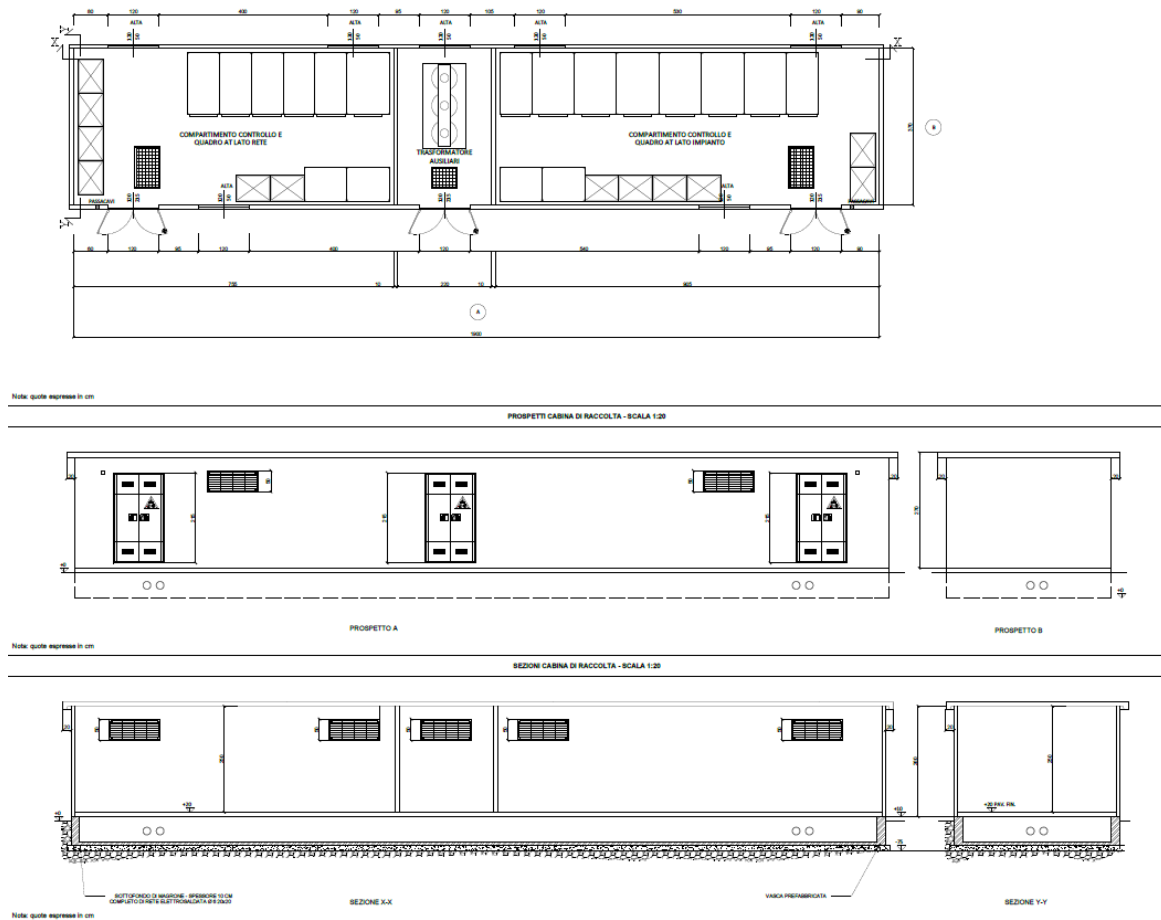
Pianta, Prospetti e Sezioni Cabina di Raccolta
